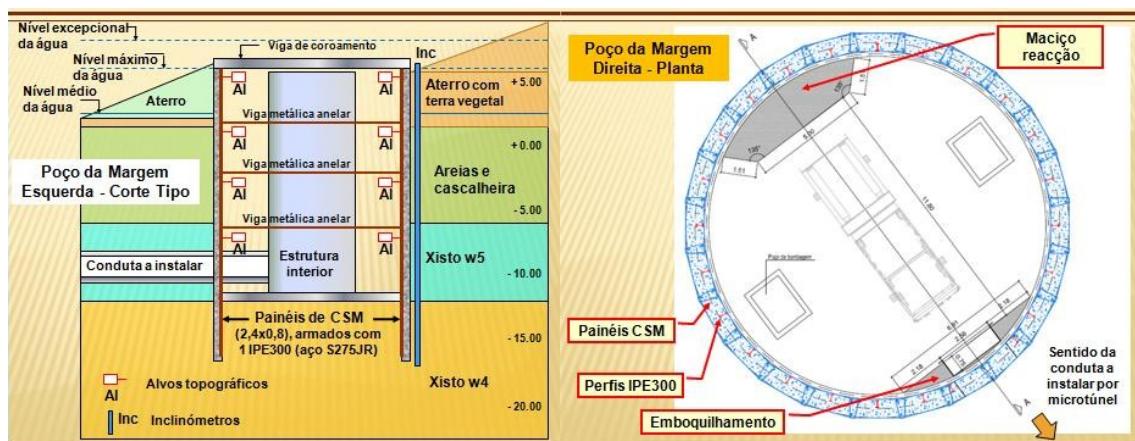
Corte tipo e planta das soluções estudadas e implementadas
